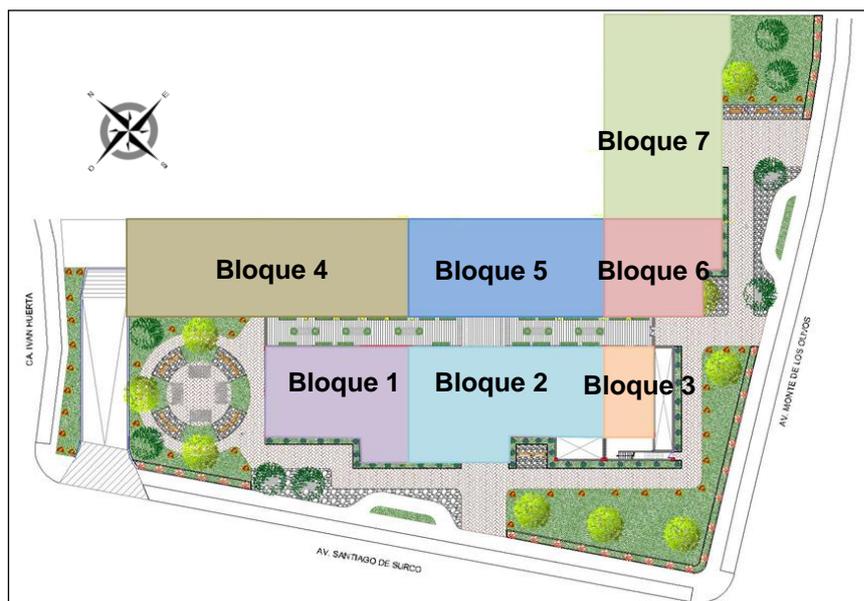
Esquema Sistema constructivo. Dividido por las juntas de dilatación
